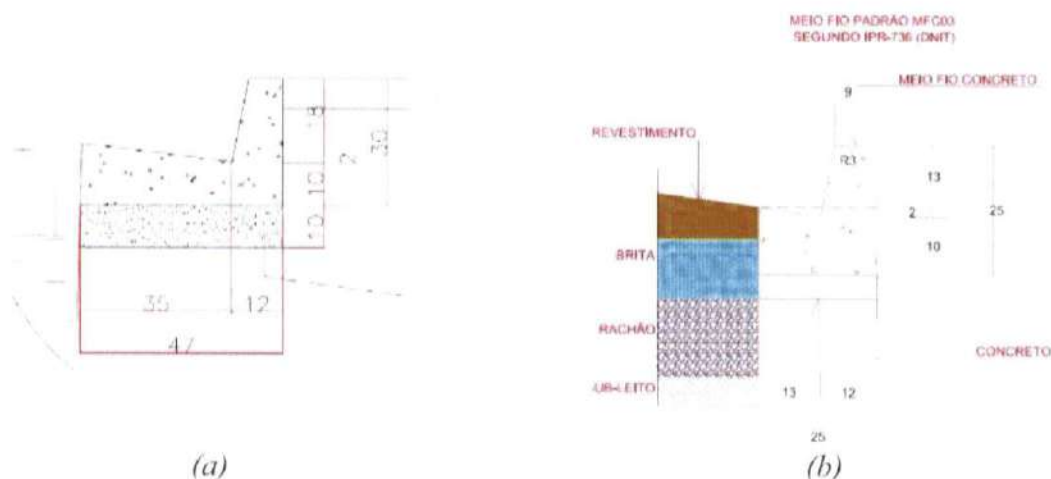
Seção transversal do meio-fio e sarjeta conjugados: (a) previsto no projeto original, na planilha orçamentária e utilizado para pagamento; e (b) executado na obra, com a nomenclatura MFC-03 DNIT.
